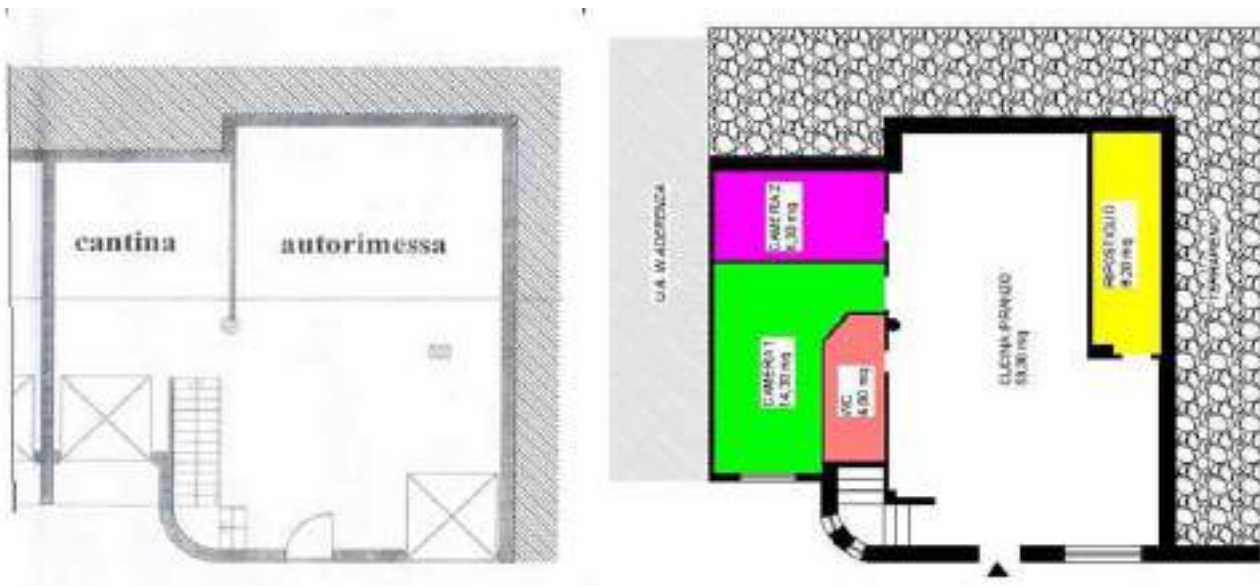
Sovrapposizione tra lo stato di fatto e il progetto assentito – Piano interrato
